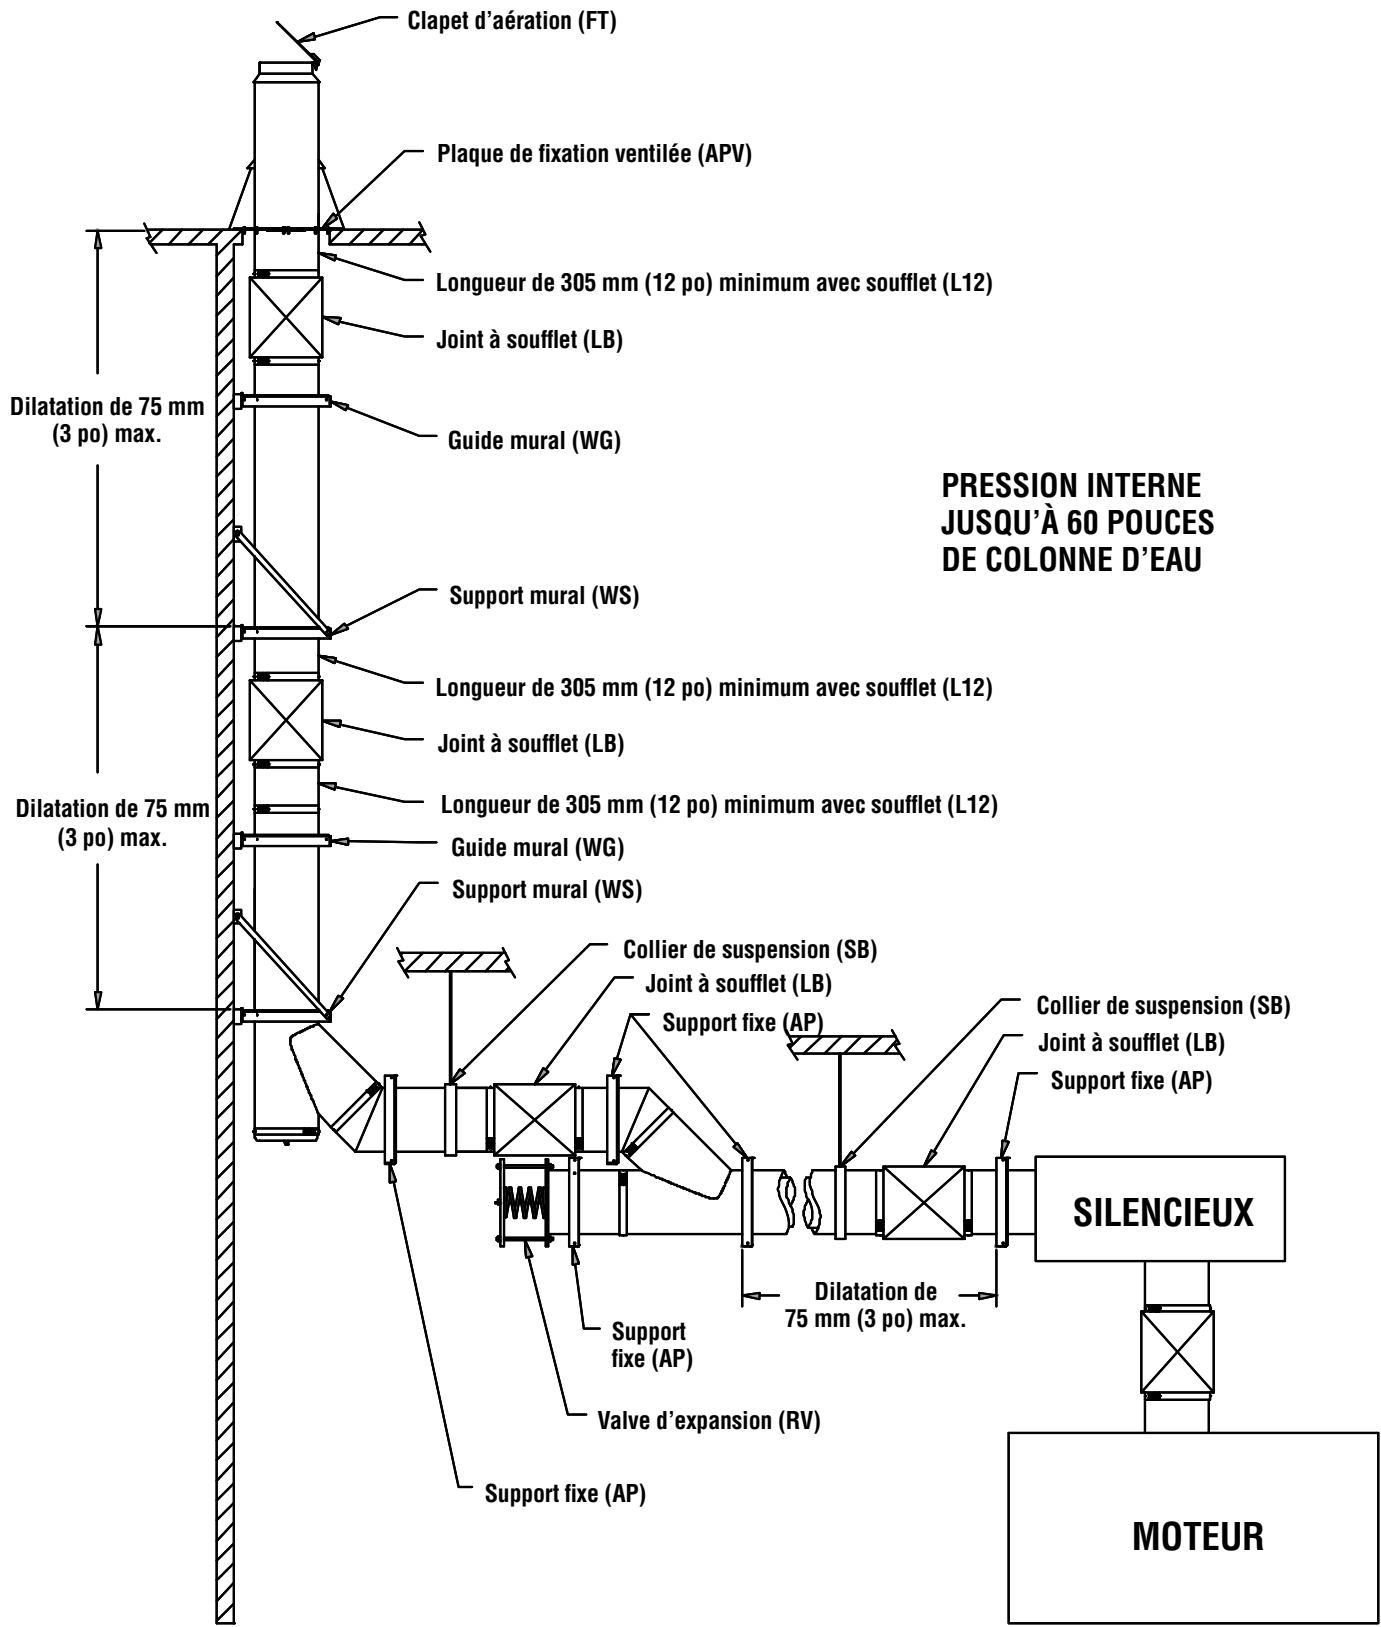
Installation d'un joint à soufflet pour un moteur Diesel
